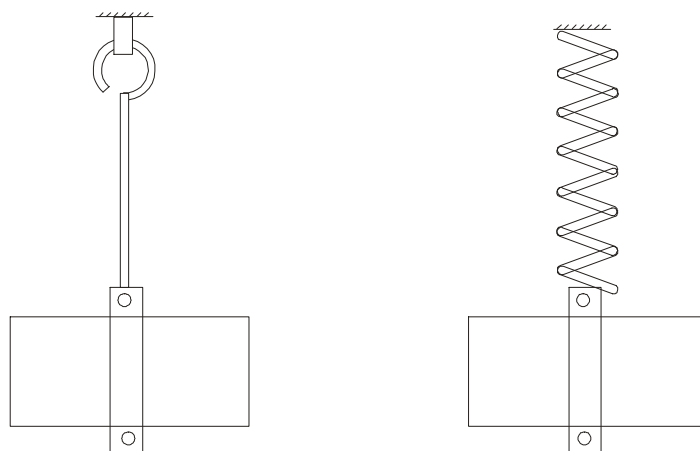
Схемы простой и пружинной подвесных опор
